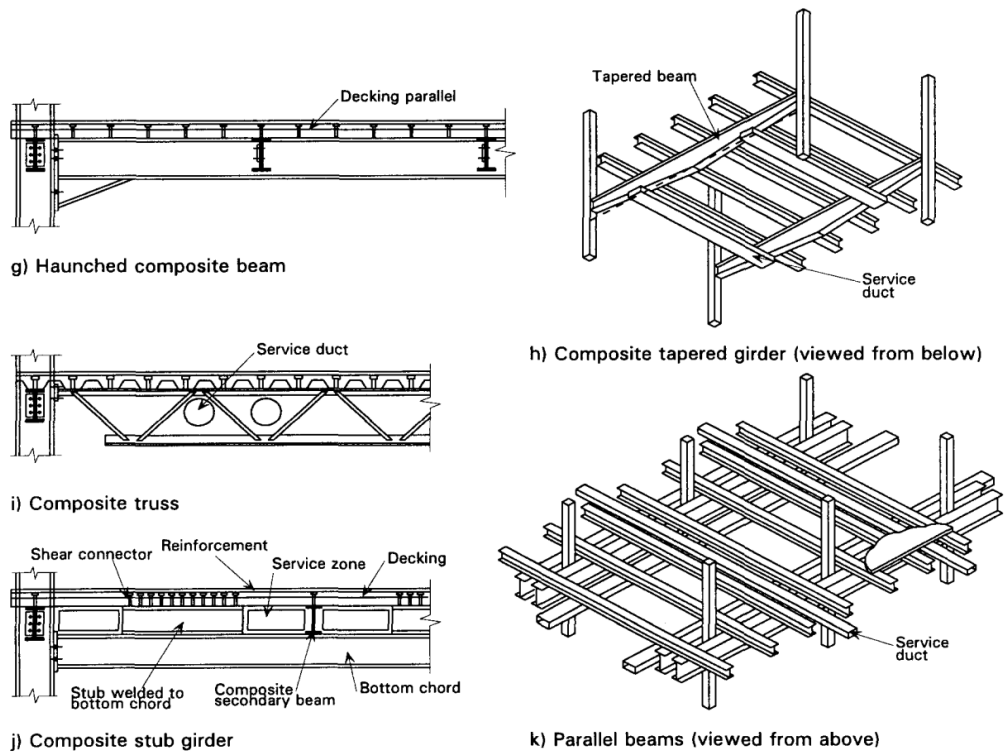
Sistemas estrutural em construção mista 2/2 (Brown *et al*, 1997).
